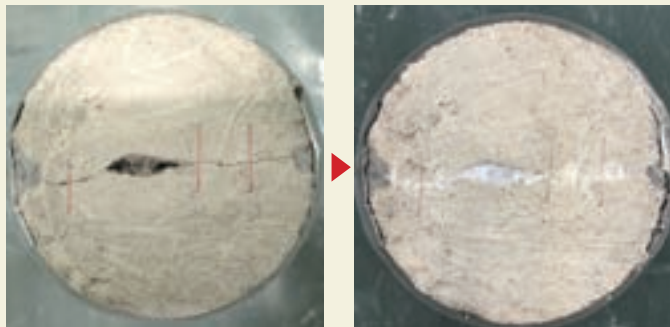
コンクリート試験体によるひび割れ閉塞状況 (20週経過後)
